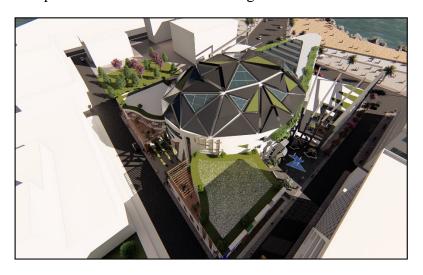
vue sur la 5eme façade. Source : auteurs.
